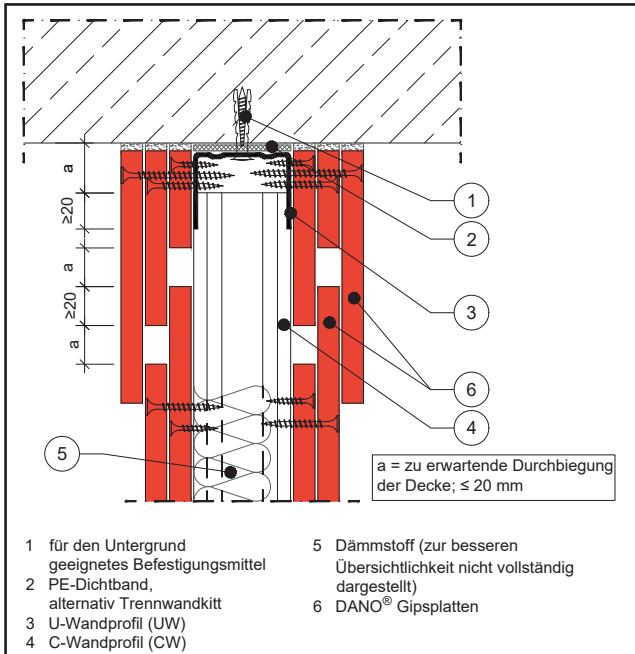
Gleitender Deckenanschluss mit Plattenstreifen
